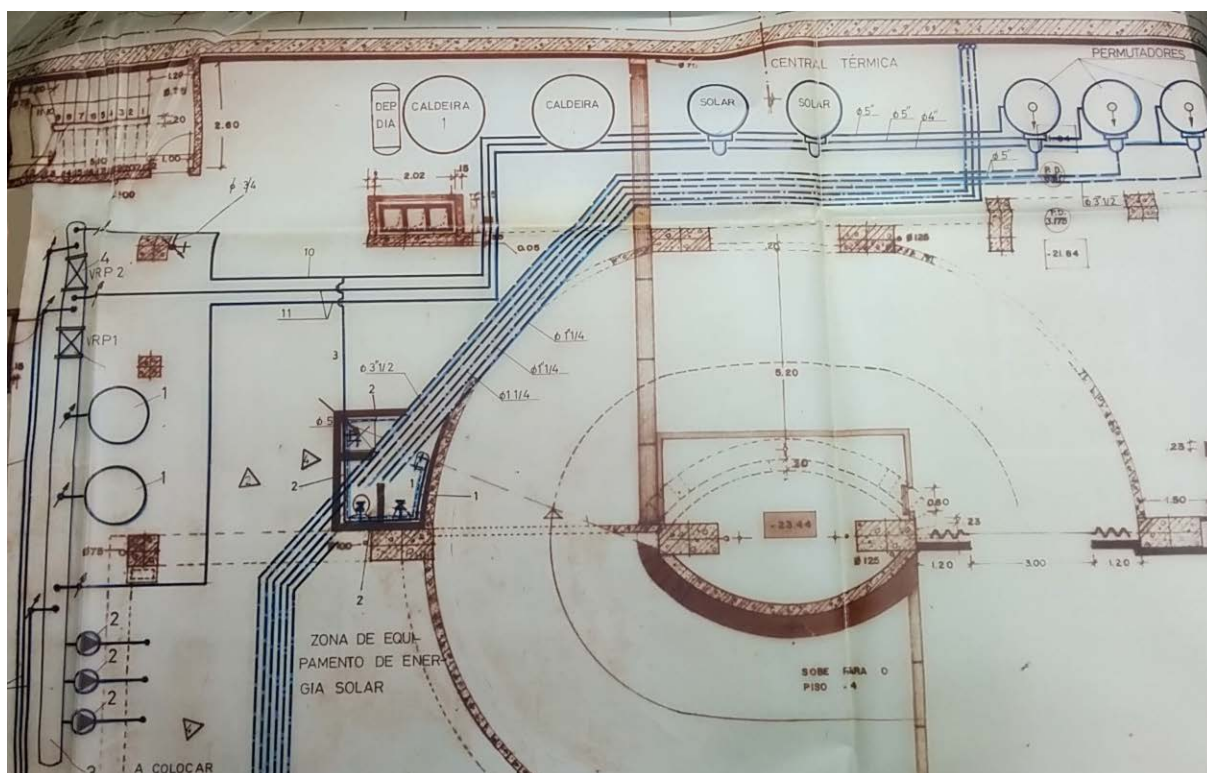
Planta do piso -5, áreas técnicas do Hotel Porto Palácio.
